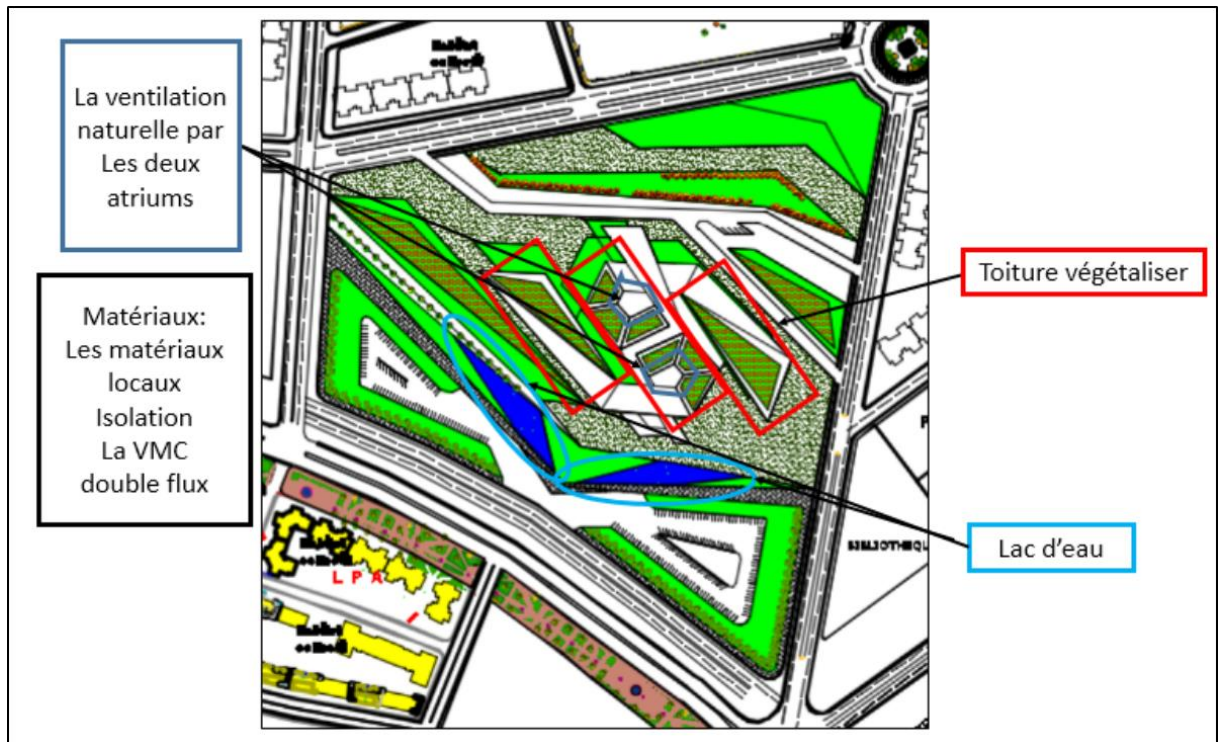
les dispositifs architecturaux represent en plan de masse , la source :l'auteur
